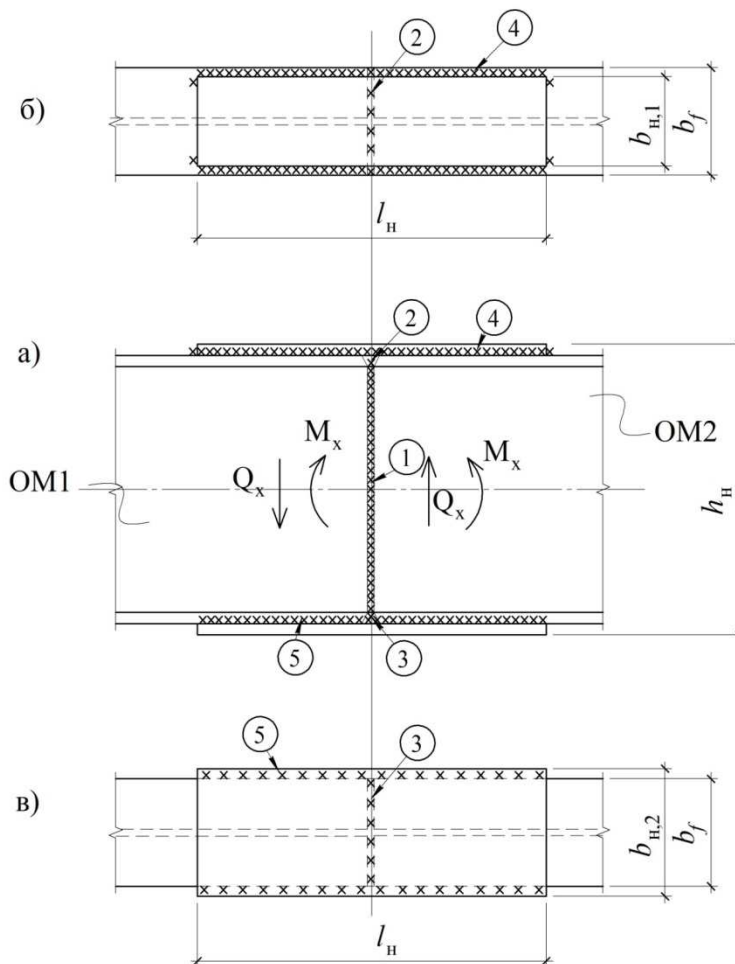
Схема прямого монтажного стыка отпавочных марок прокатной балки с дополнительными наладками на поясах. Цифрами указана рекомендуемая последовательность выполнения сварки (1, 2, 3, 4, 5); а) основная проекция; б) вид сверху; в) вид снизу
